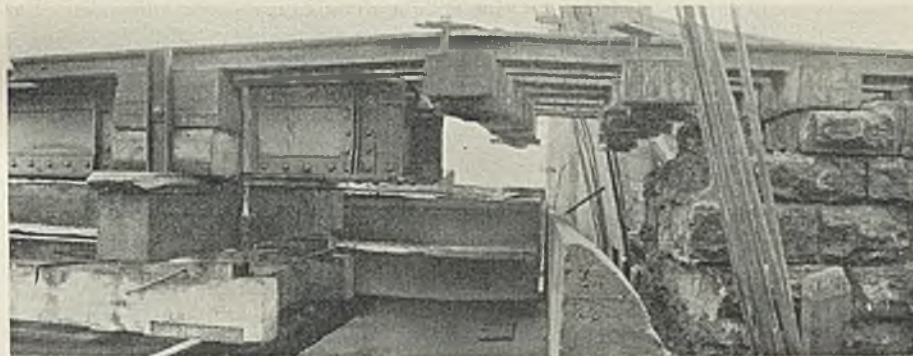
Schienenaufhängung für den Umbau der Widerlagerköpfe.
